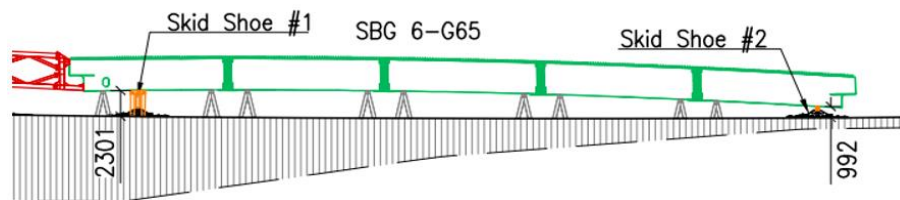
Ilustrasi Pemasangan *Steel Tub Girder* 65 m dan *Nose Beam
